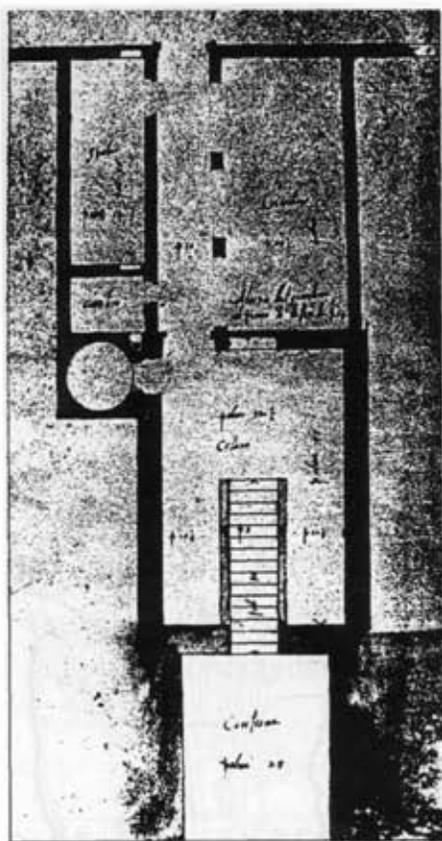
Pianta di Caprarola lungo il rettilineo del Vignola.
